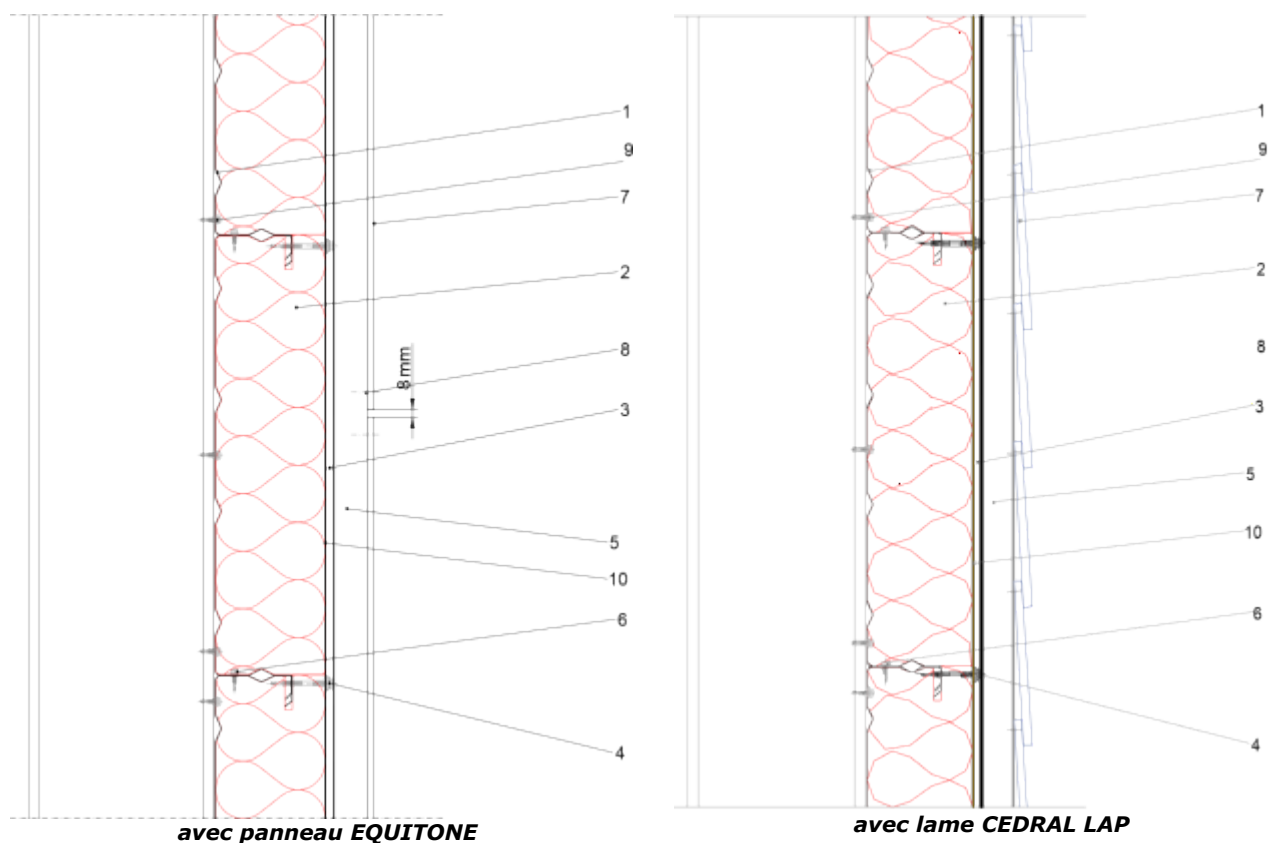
Coupe verticale en partie courante (avec tôle pare-pluie)
